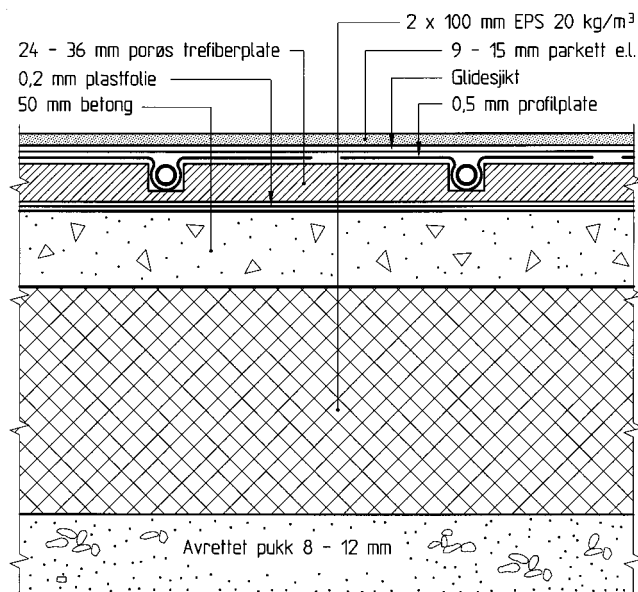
Lett gulvvarmeanlegg over godt isolert betonggulv.
